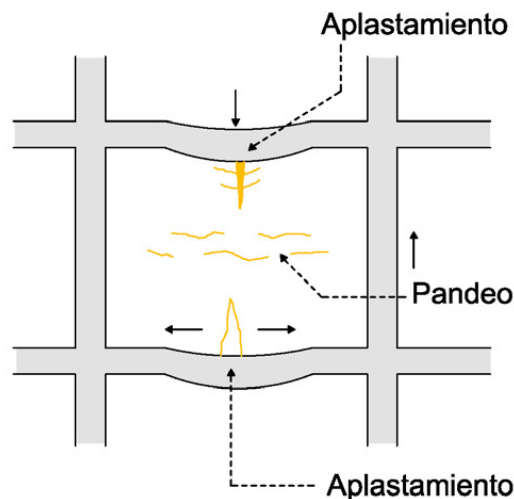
Grietas por deformación de un forjado.
